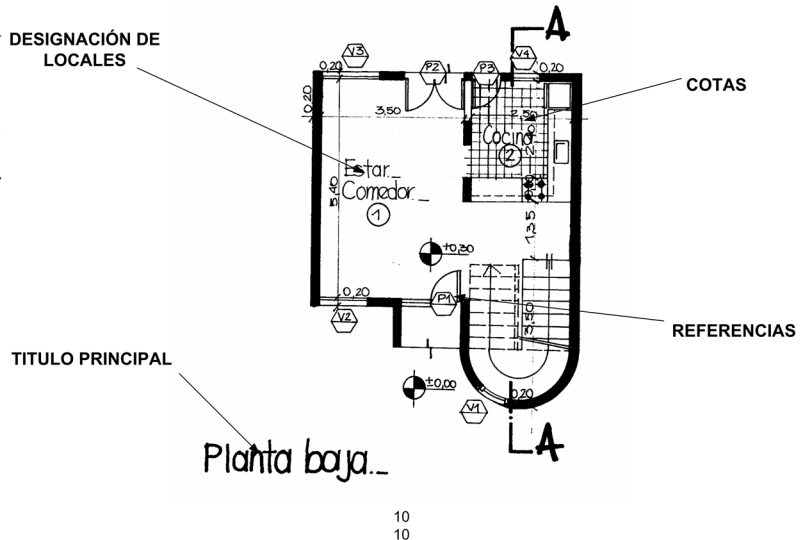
Plano de planta arquitectónica. Fuente: Pereyra V.
